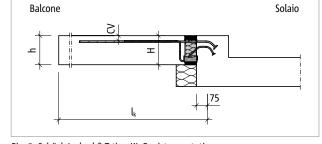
Schöck Isokorb® T tipo KL-U: sistema statico
